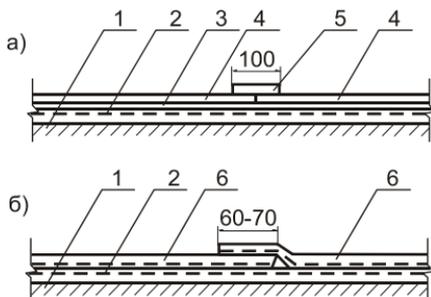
Конструкция соединений гидроизоляции: а — встык;
